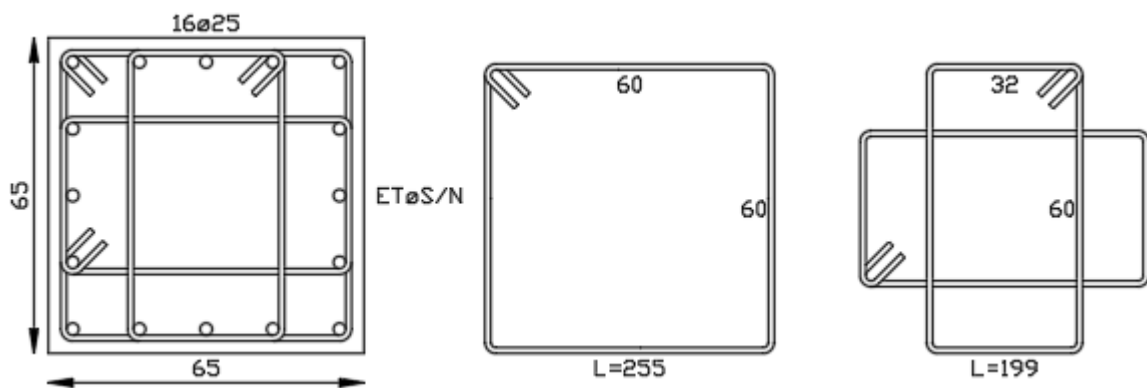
Columnas C03, Estructura de 20 pisos.
